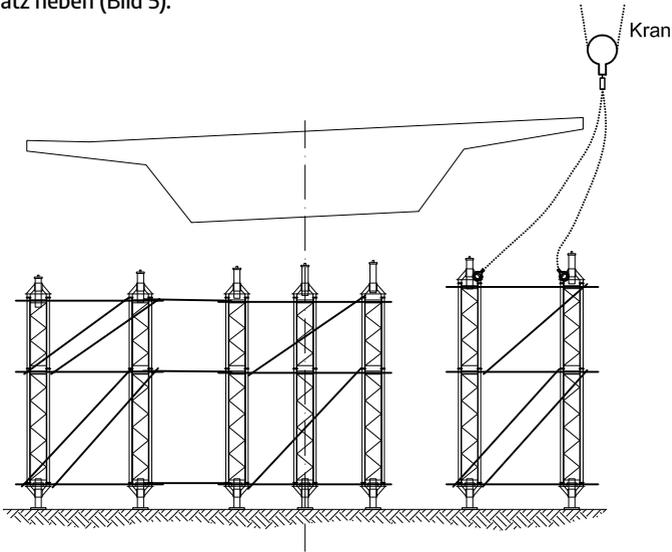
Ausbau der äußersten Scheibe mit dem Hebezeug
